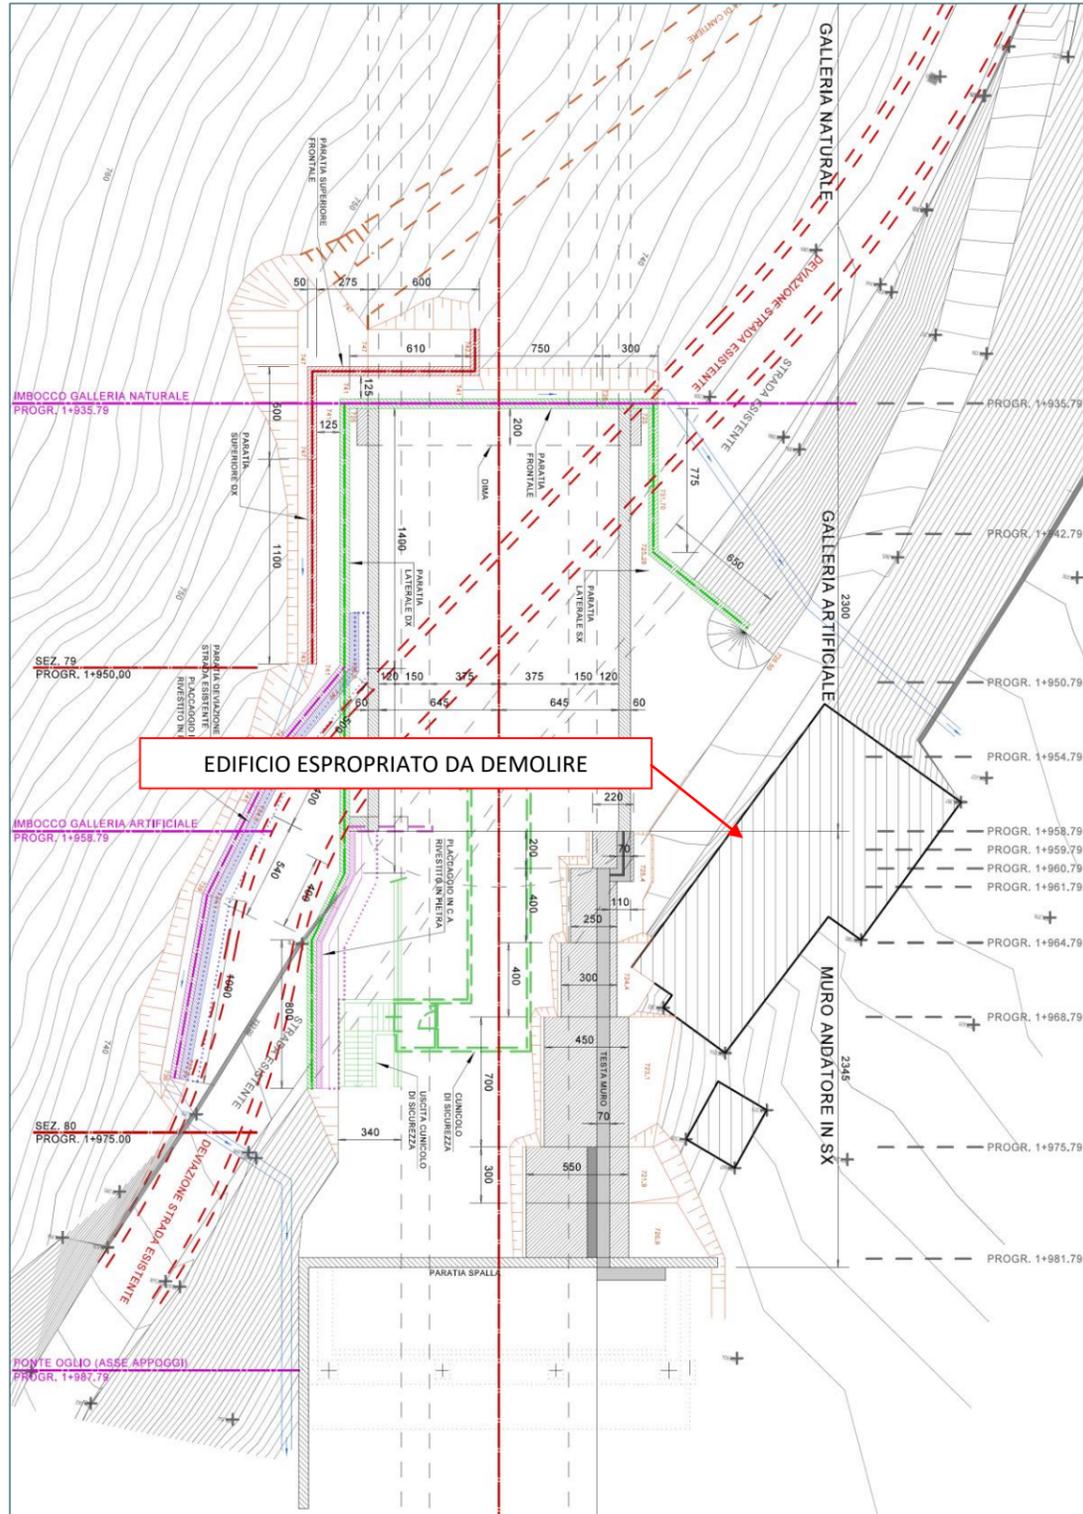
Galleria naturale Imbocco – Paratie berlinesi – Pianta
